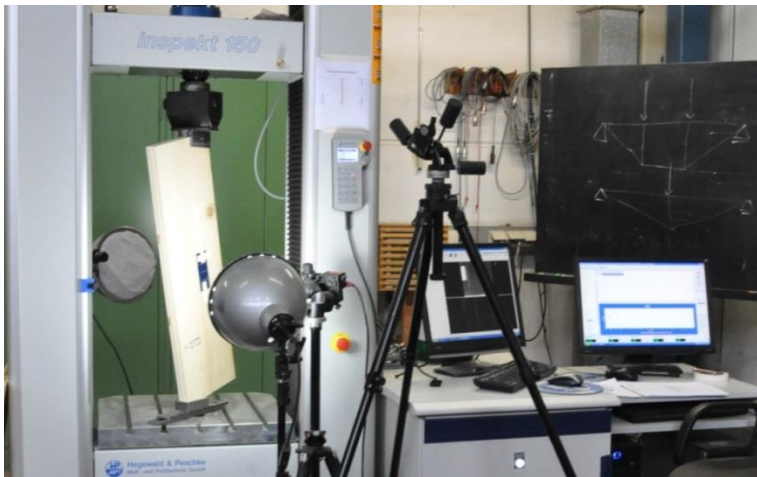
Prüfstand mit eingebautem Prüfkörper
